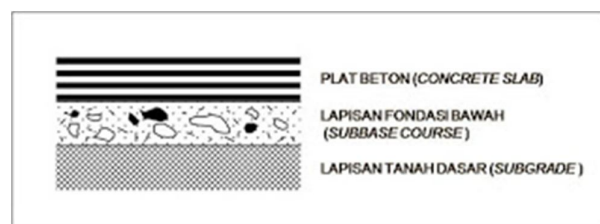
Rigid Pavement (perkerasan Kaku)
